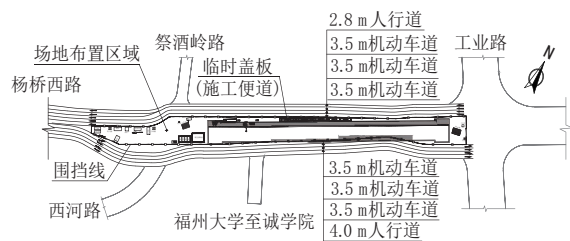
凤凰池站主体施工场地布置及交通组织平面示意图
